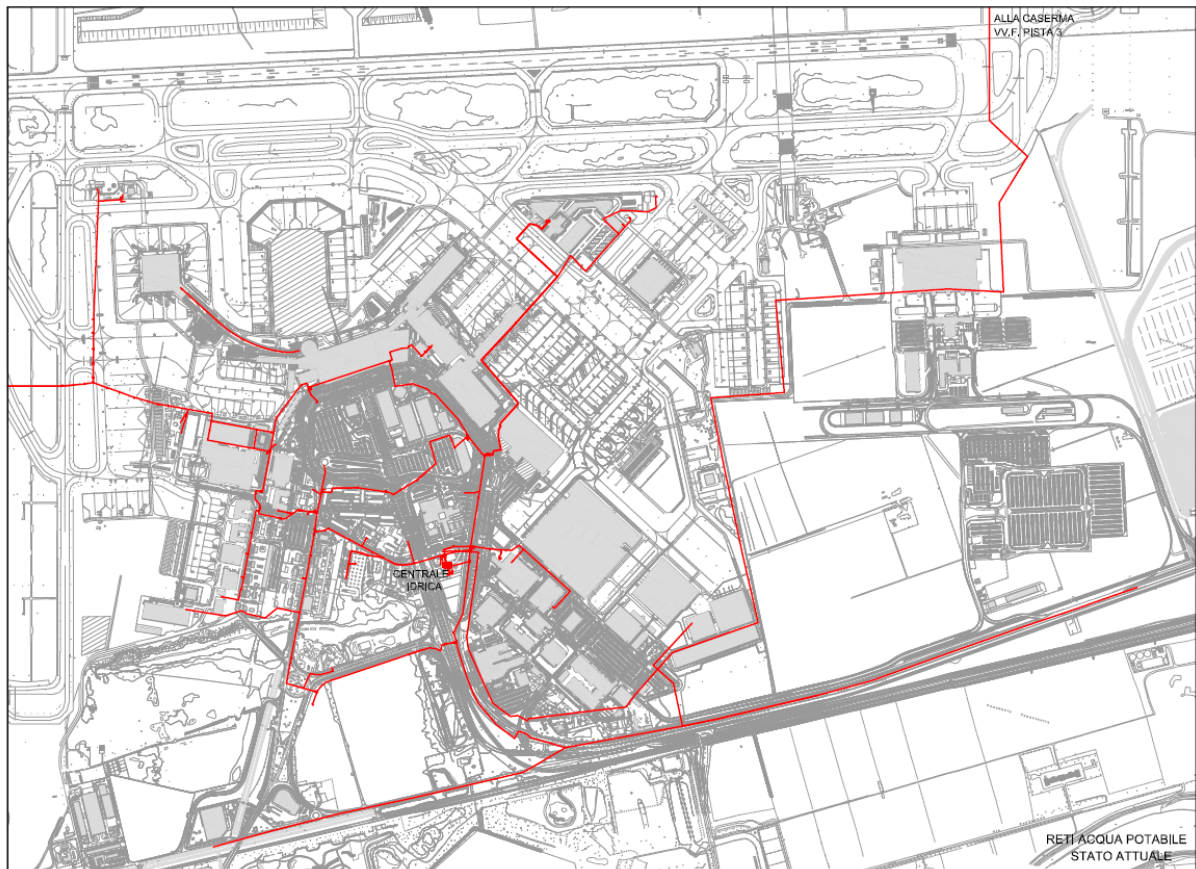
Planimetria delle reti di distribuzione dell'acqua potabile
